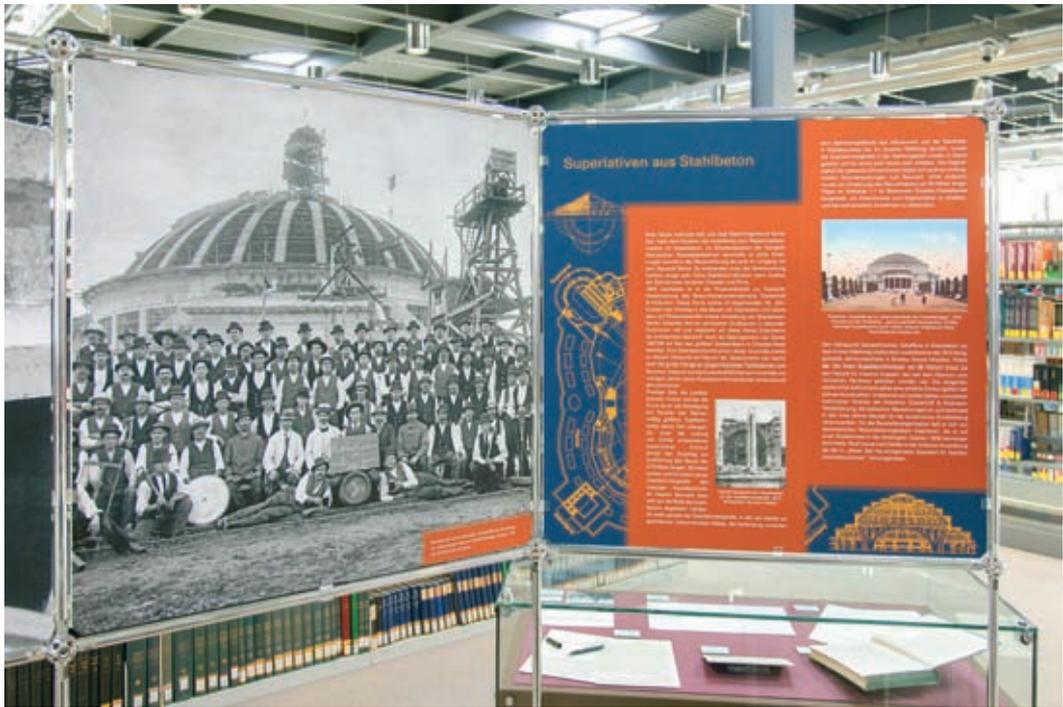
Jahrhunderthalle Breslau und zugehörige Infotafel zu ausgeführten Bauwerken mit Gehlers Beteiligung | Foto: Sven Hofmann
